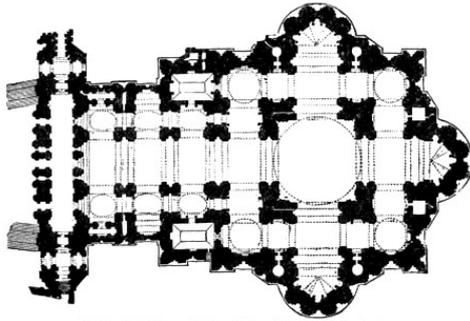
Basílica de San Pedro. Plano de Maderno, 1626.
